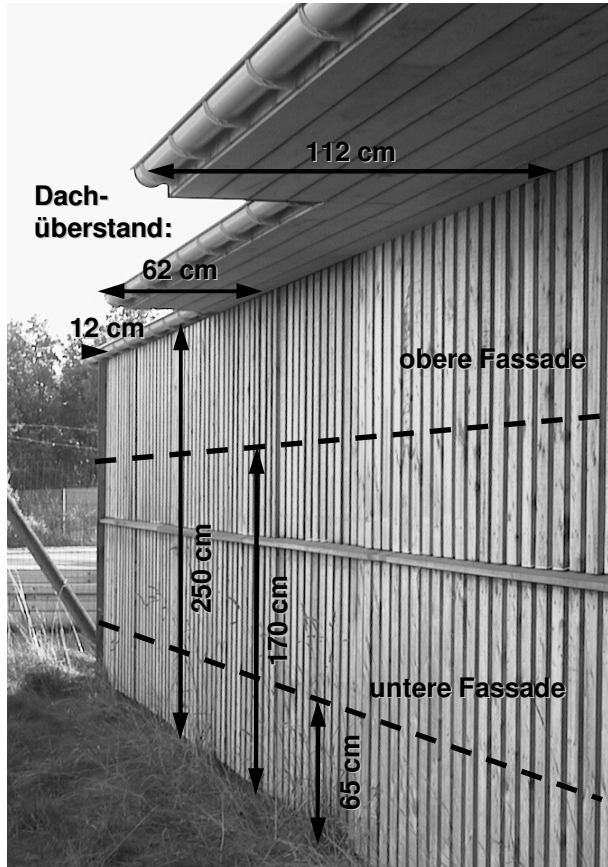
Boden-Deckel-Schalung an einer Fassade mit unterschiedlichen Dachüberständen in Taastrup, Dänemark. Gestrichelte Linien markieren die Höhe der Messstellen an der oberen und unteren Fassade.
